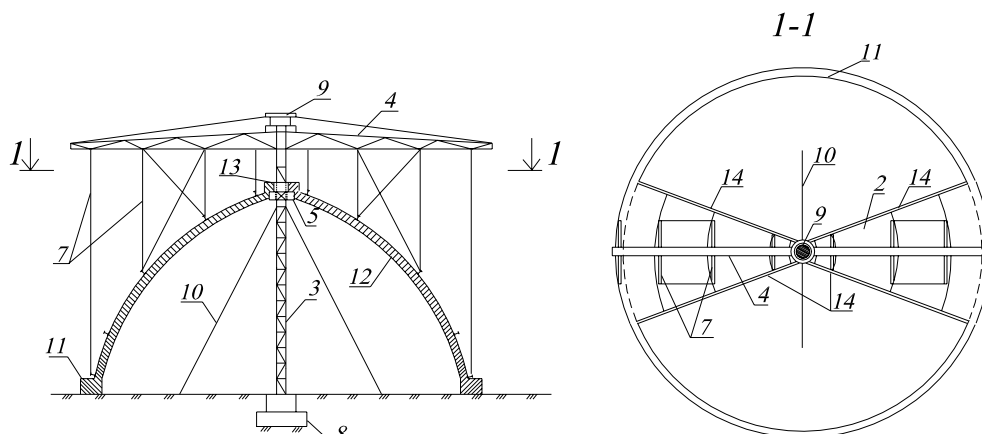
Забетонированные первые два сектора купола: 2 – опалубка купола; 3 – временная опора; 4 – консольная стрела; 5 – неподвижное кольцо; 7 – связи; 8 – фундамент временной опоры; 9 – гидродомкрат; 10 – растяжки; 11 – нижнее опорное кольцо; 12 – оболочка купола; 13 – верхнее опорное кольцо; 14 – ограничительные бортики.
